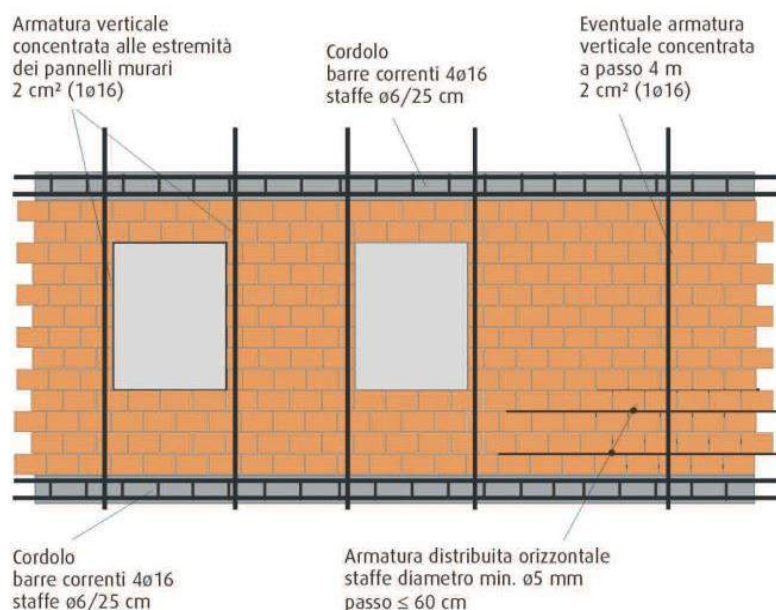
Schema di disposizione delle armature verticali ed orizzontali nella muratura armata.
